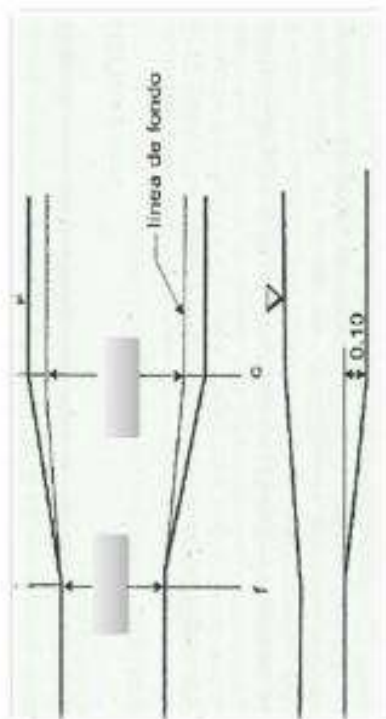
Se observa la alcantarilla y la compuerta del canal de tierra pendiente de diseño y construcción
